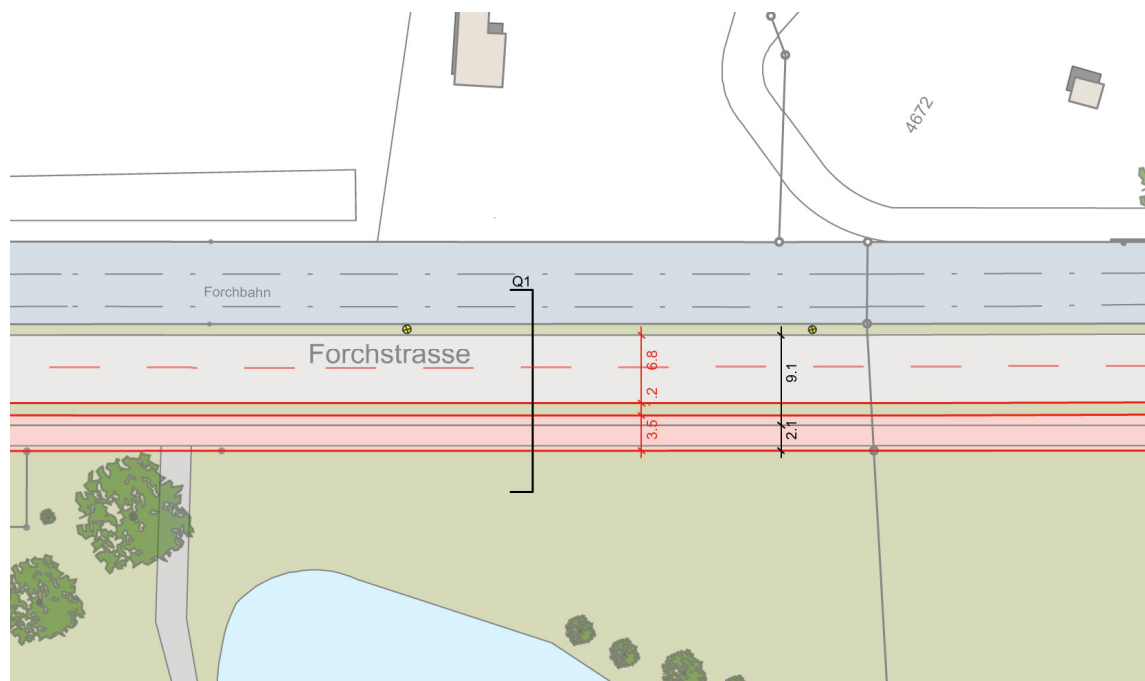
Ausschnitt Konzeptplan Ausserortsbereich
